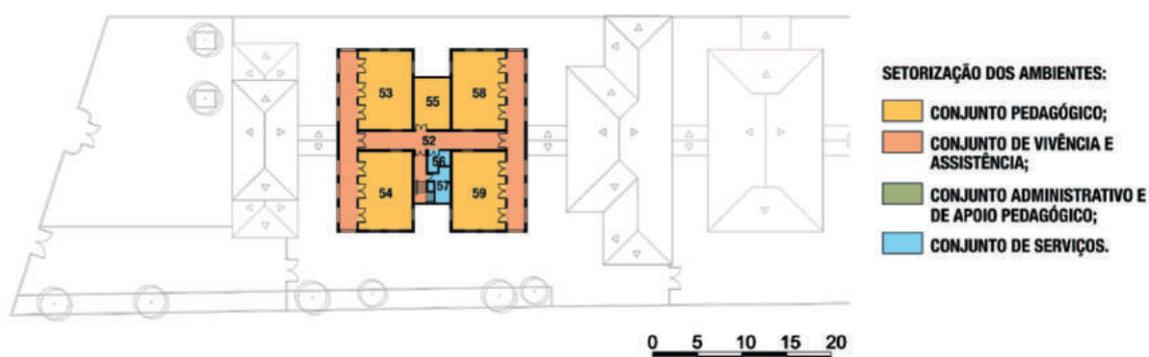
planta baixa do primeiro pavimento da Escola Municipal Sarmiento
